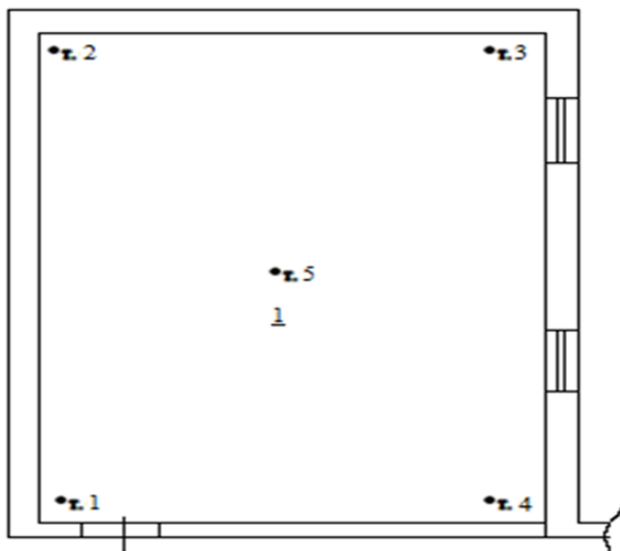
План квартири № 13 на вул. Набережна Перемоги, 58
